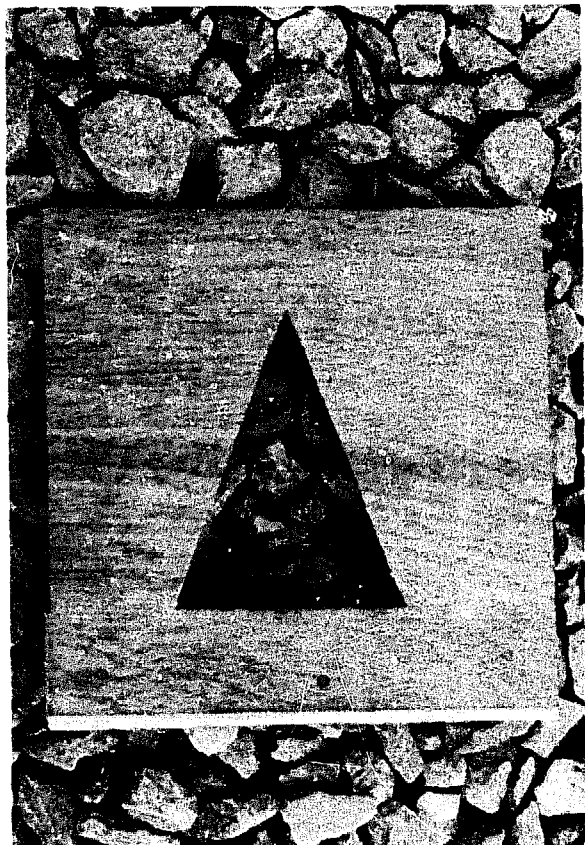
Dans un contreplaqué de 5 mm découper un carré de 20 cm de côté.
